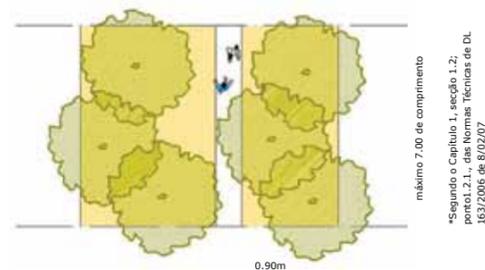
Caminhos pedonais dentro de áreas plantadas, dimensão mínima
